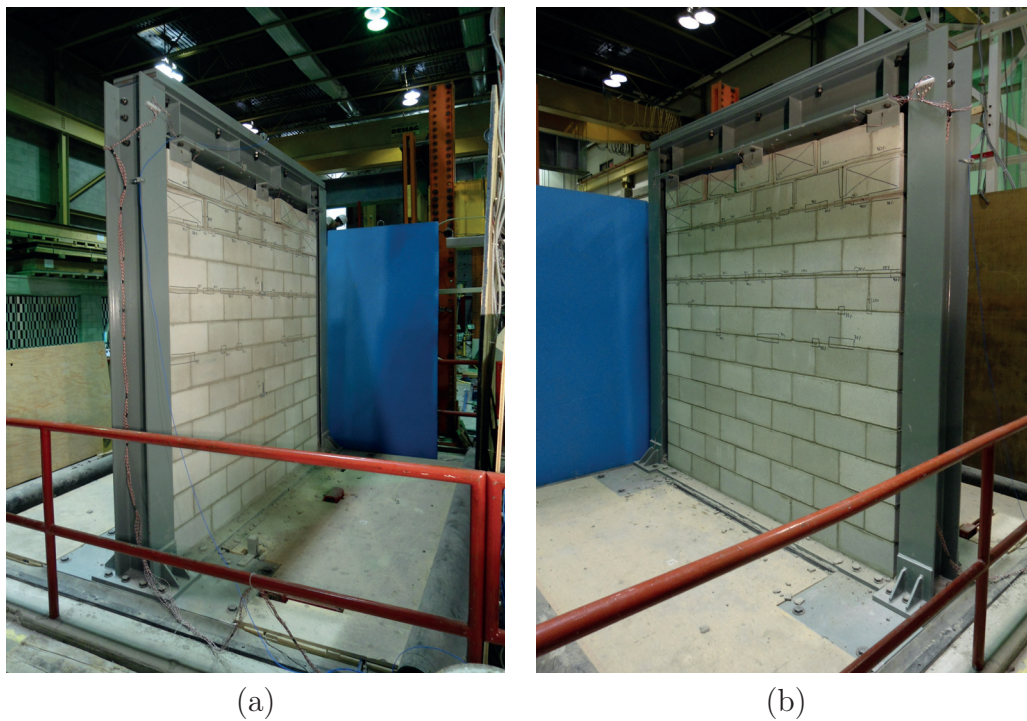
Photos de l'endommagement global du mur 2 après le dernier essai (MAL12-0.70) (a) façade avant (b) façade arrière
